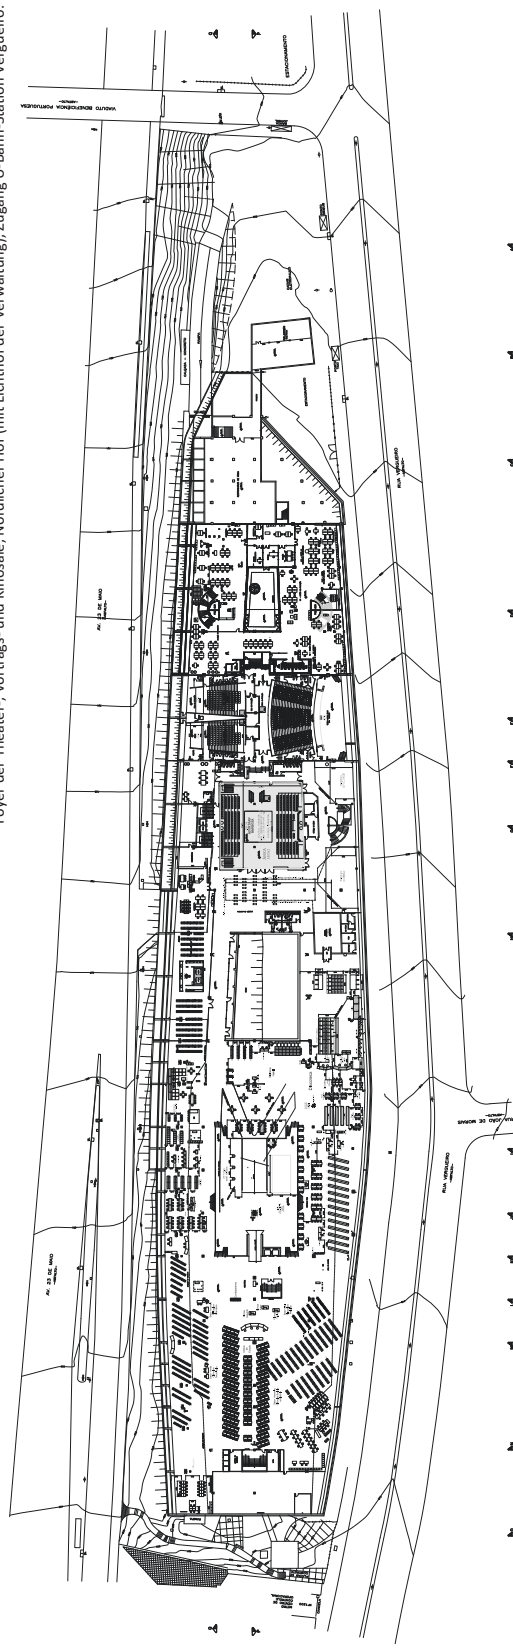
Grundriss 1. Untergeschoss
